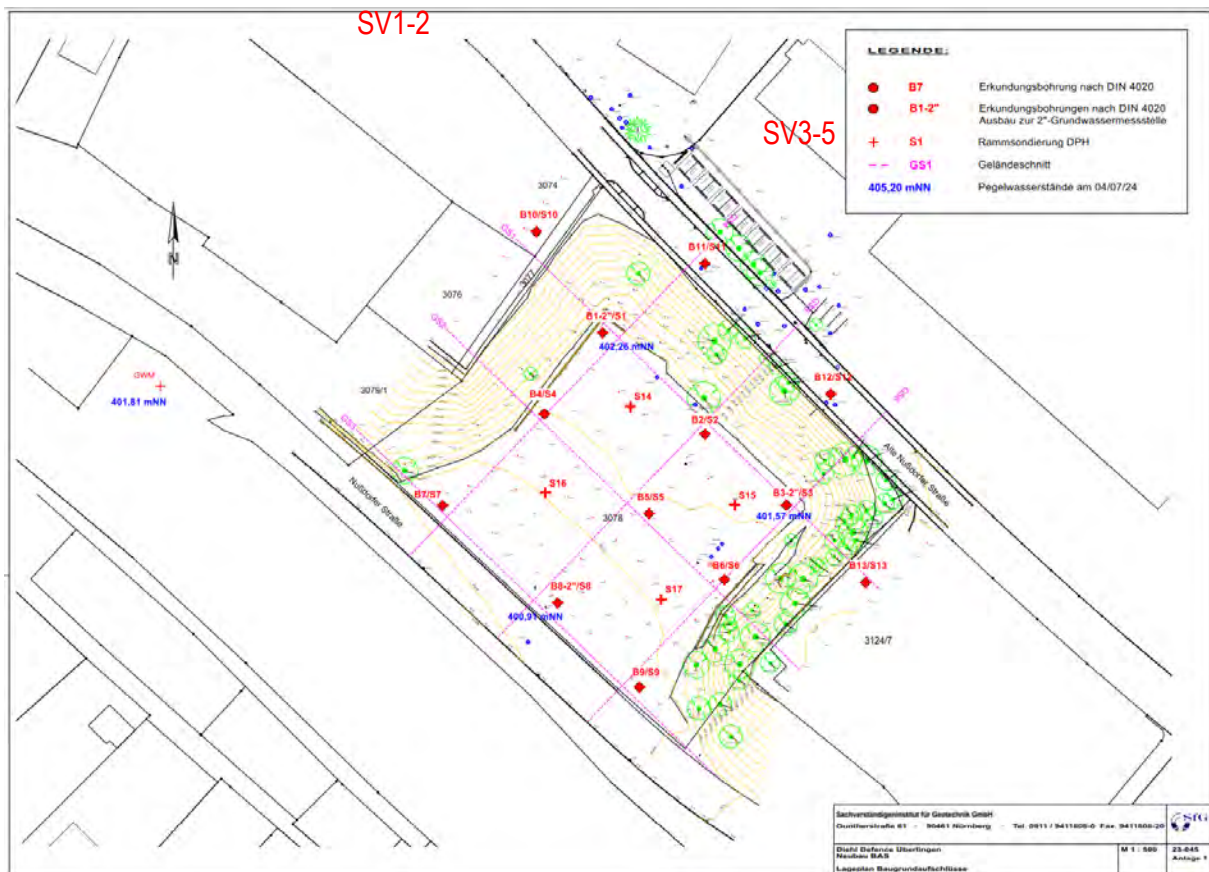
Lageplan Baugrundaufschlüsse von Sachverständigeninstitut für Geotechnik GmbH – Stand:09/2024
